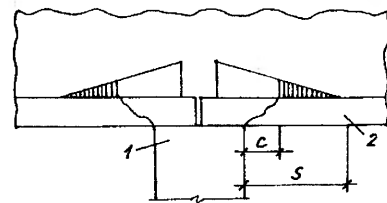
Определение поперечной силы у опор рандбалки: 1 - опора; 2 - рандбалка
